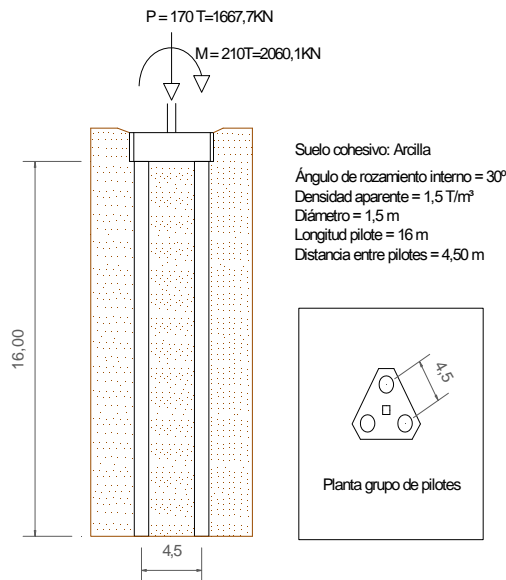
Croquis de grupo de 3 pilotes con diámetro 1,5 m y longitud pilote 16 m
